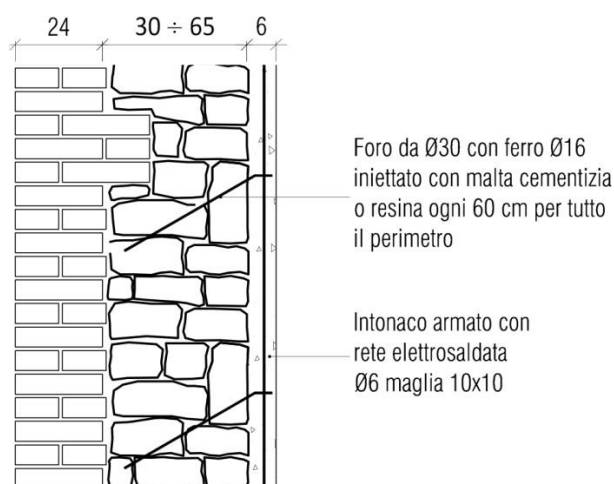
Dettaglio in sezione dell'intonaco armato per la tipologia MUR3
